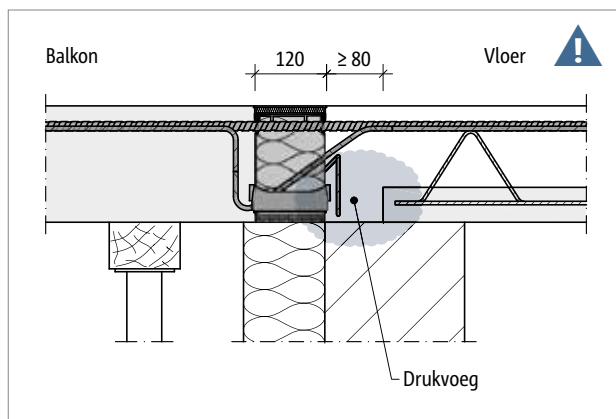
Schöck Isokorf® CXT type K-E: prefabbalkon met hoger liggende vloerplaat op een wand van gewapend beton
